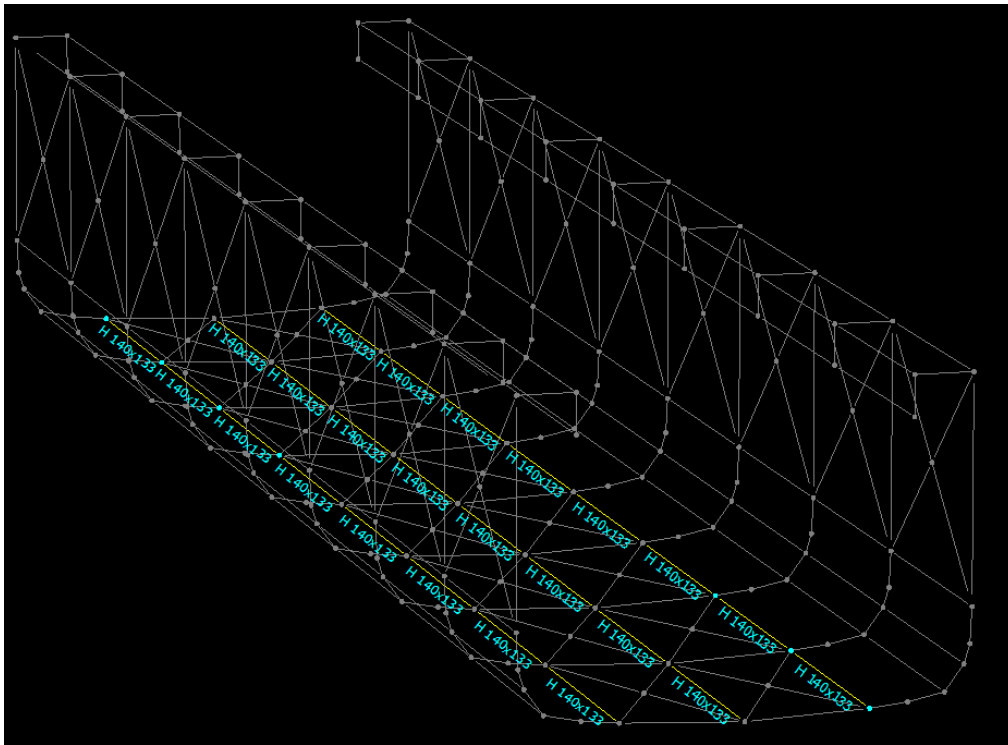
Reforzamiento longitudinal de abajo de la estructura de protección.
